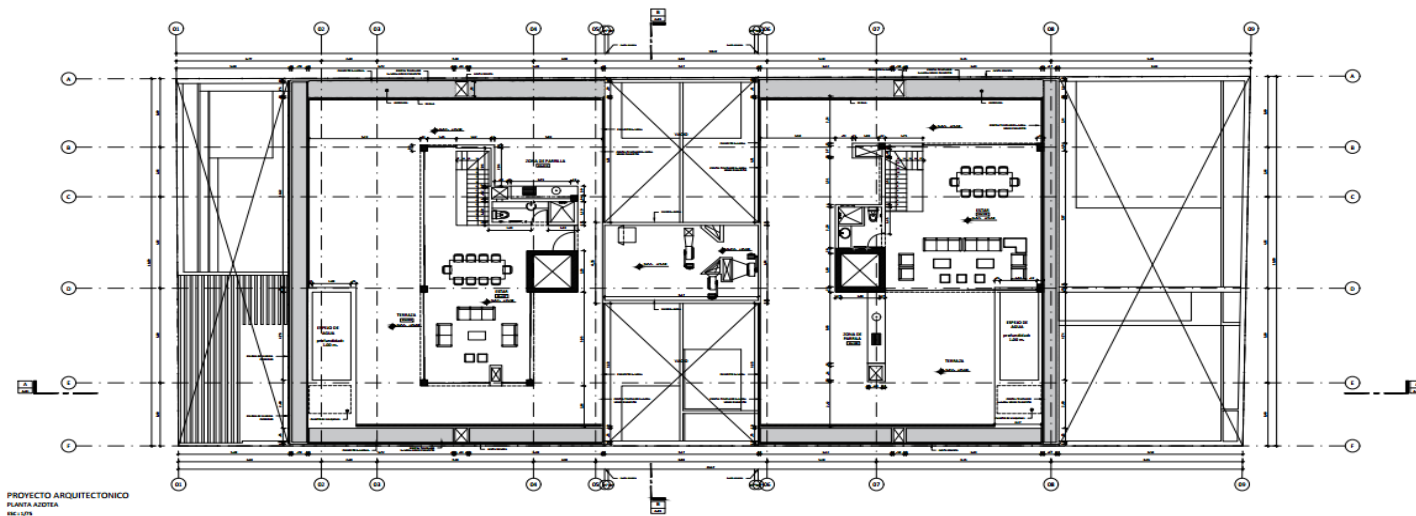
Plano de distribución arquitectónica típica del 2º – 7º nivel
